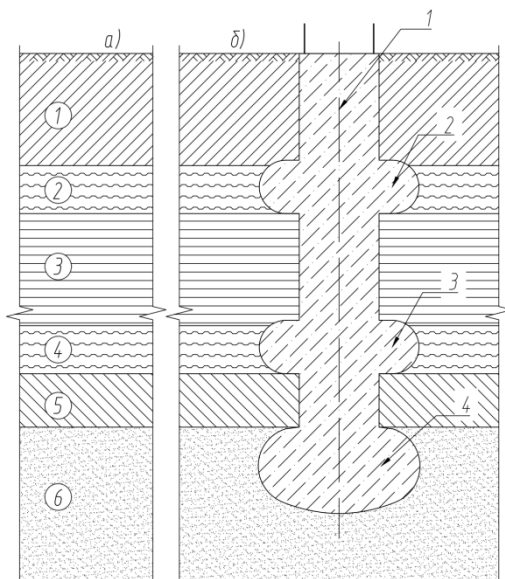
Врезка в инженерно-геологический разрез буровой грунтобетонной сваи с множественными уширениями: (1) - (6) – инженерно-геологические элементы (ИГЭ); (2), (4) – слабые ИГЭ; 1 – железобетонный ствол сваи; 2, 3, 4 – уширения (подпятники)
